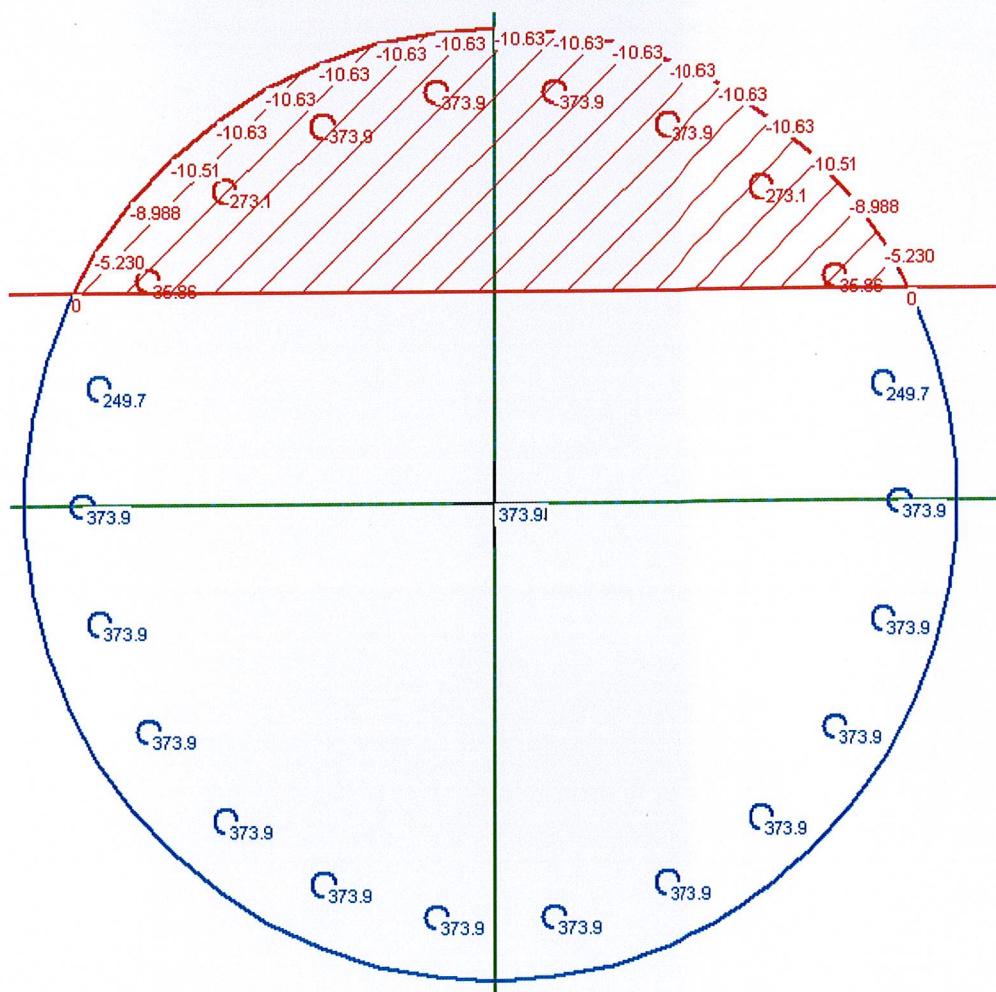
(Sforcimet ne armature dhe beton per gjendjen kufitare te fundit)
